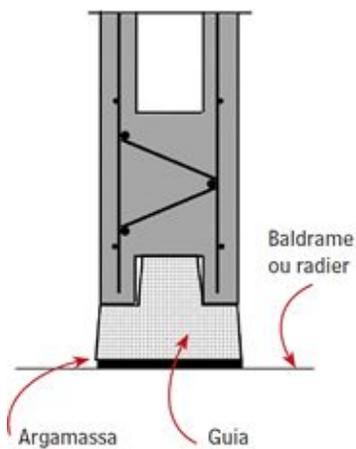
Esquema geral da interface painel e fundação – Painel apoiado sobre guia de concreto
